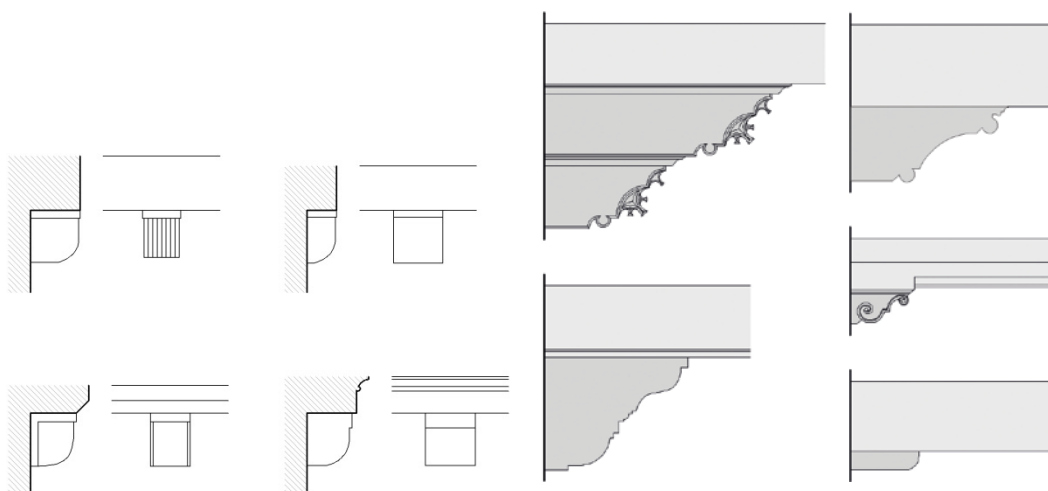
a y b. Canes de piedra y ménsulas de madera.
